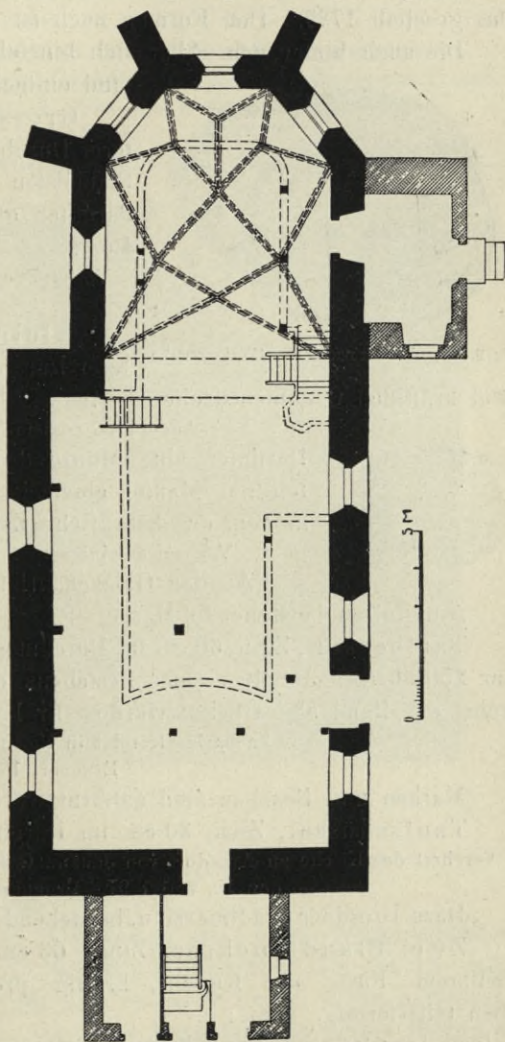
Arnsdorf, Grundriss der Kirche.
